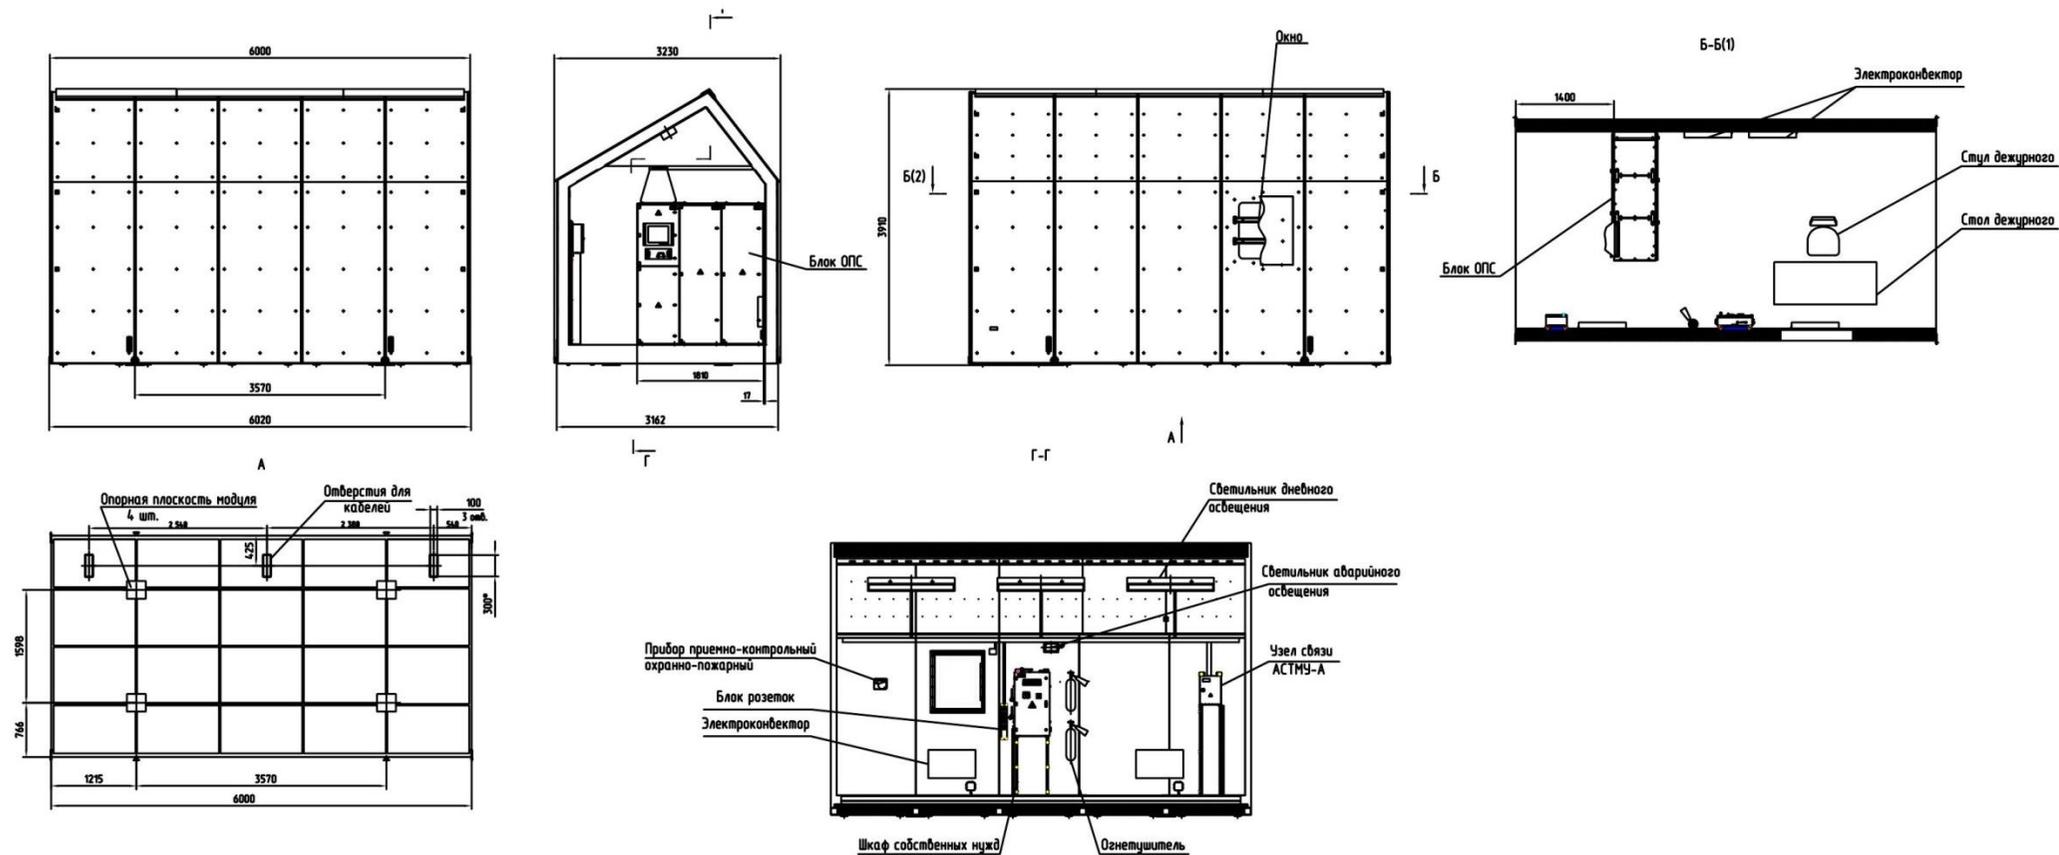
Габаритный чертеж проходного модуля ОПС
